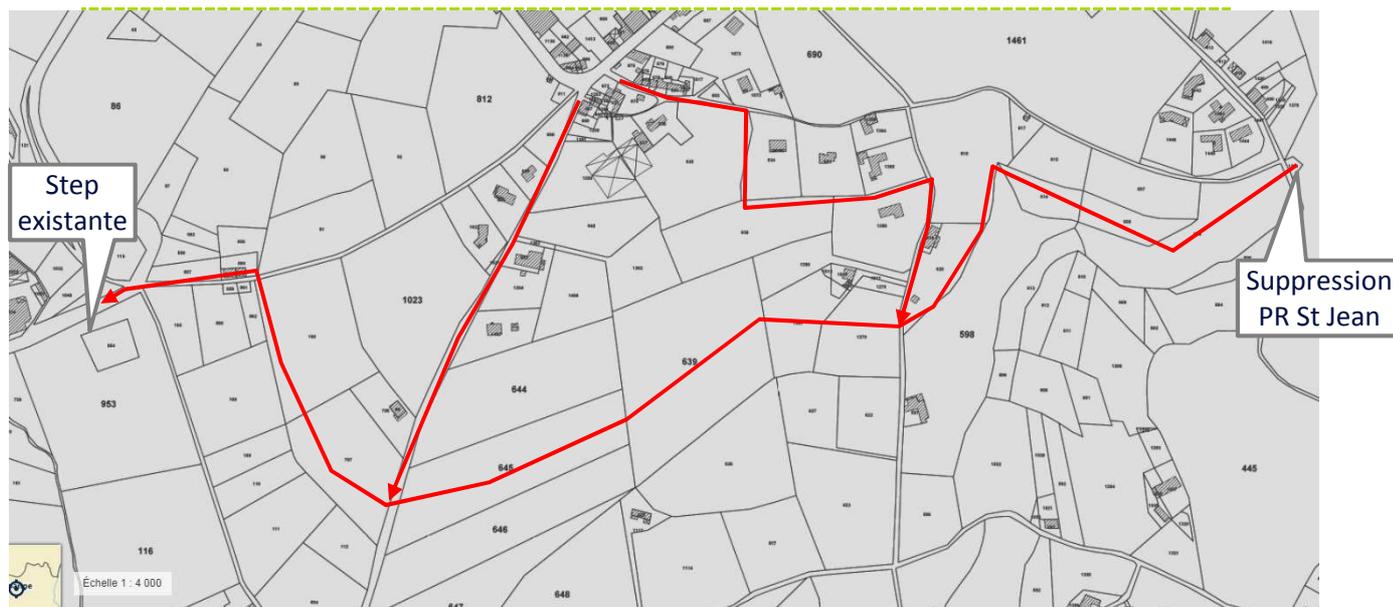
Plan de situation des travaux solution raccordement sur la STEP
